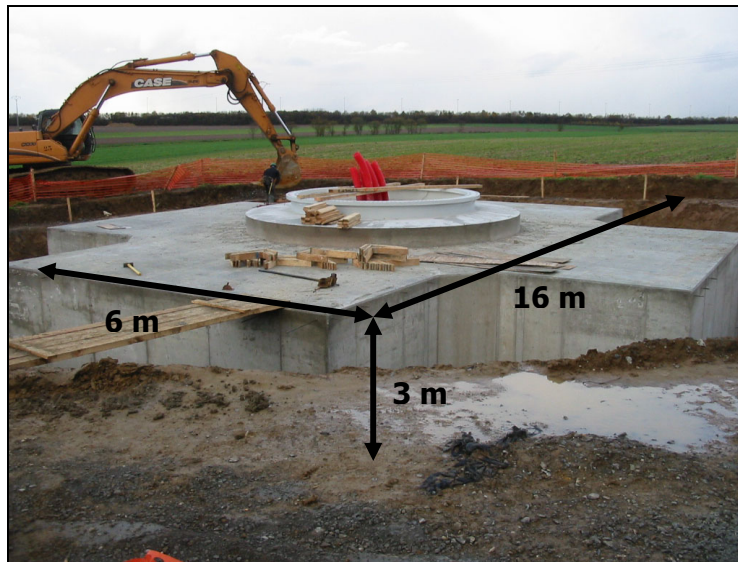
Fondation 'cruciforme' d'une éolienne.
